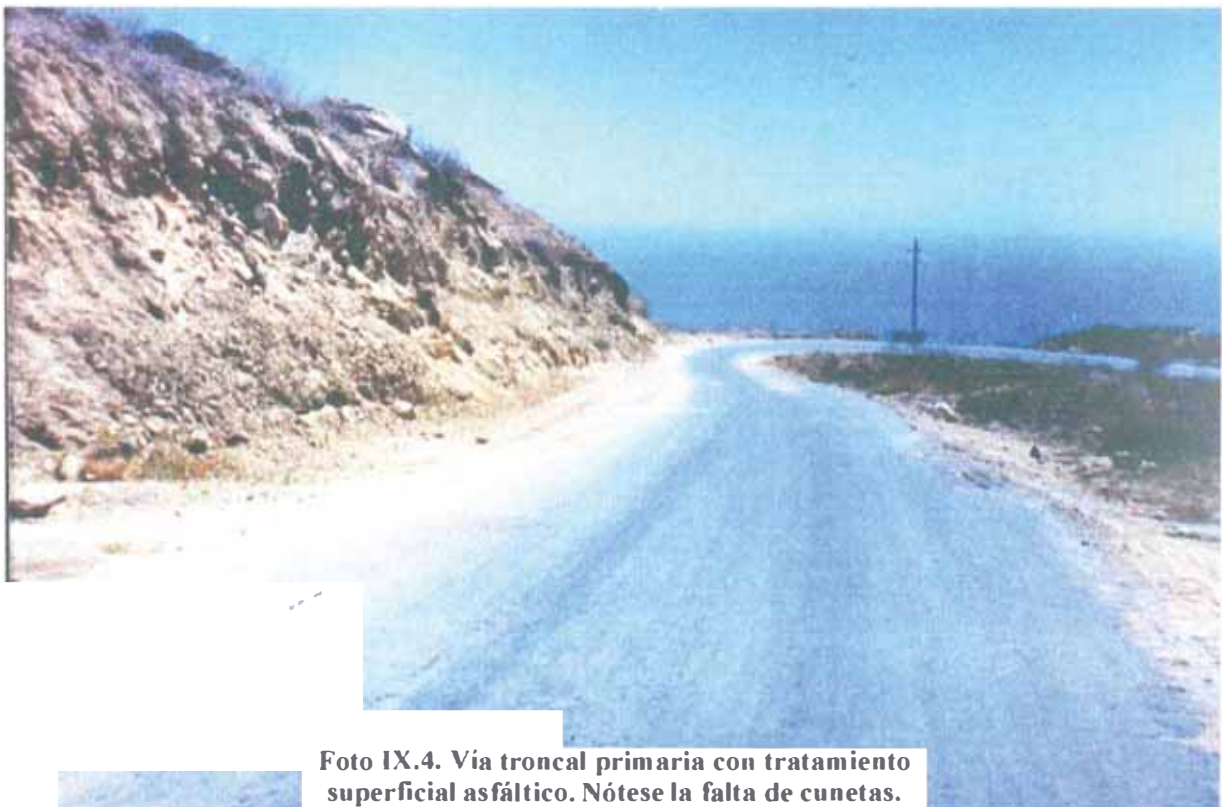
Vía troncal primaria con tratamiento superficial asfáltico. Nótese la falta de cunetas.
